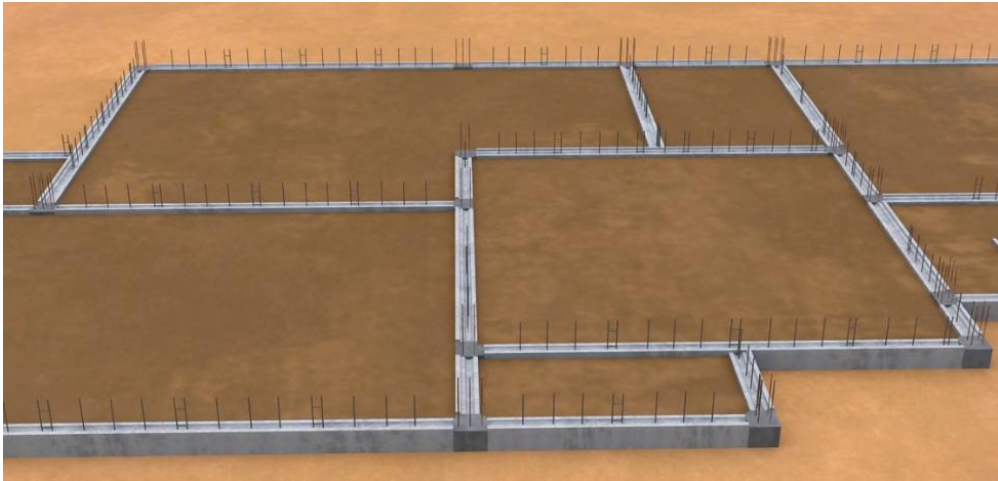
墙下条形基础施工（需预埋墙体竖向连接钢筋）
